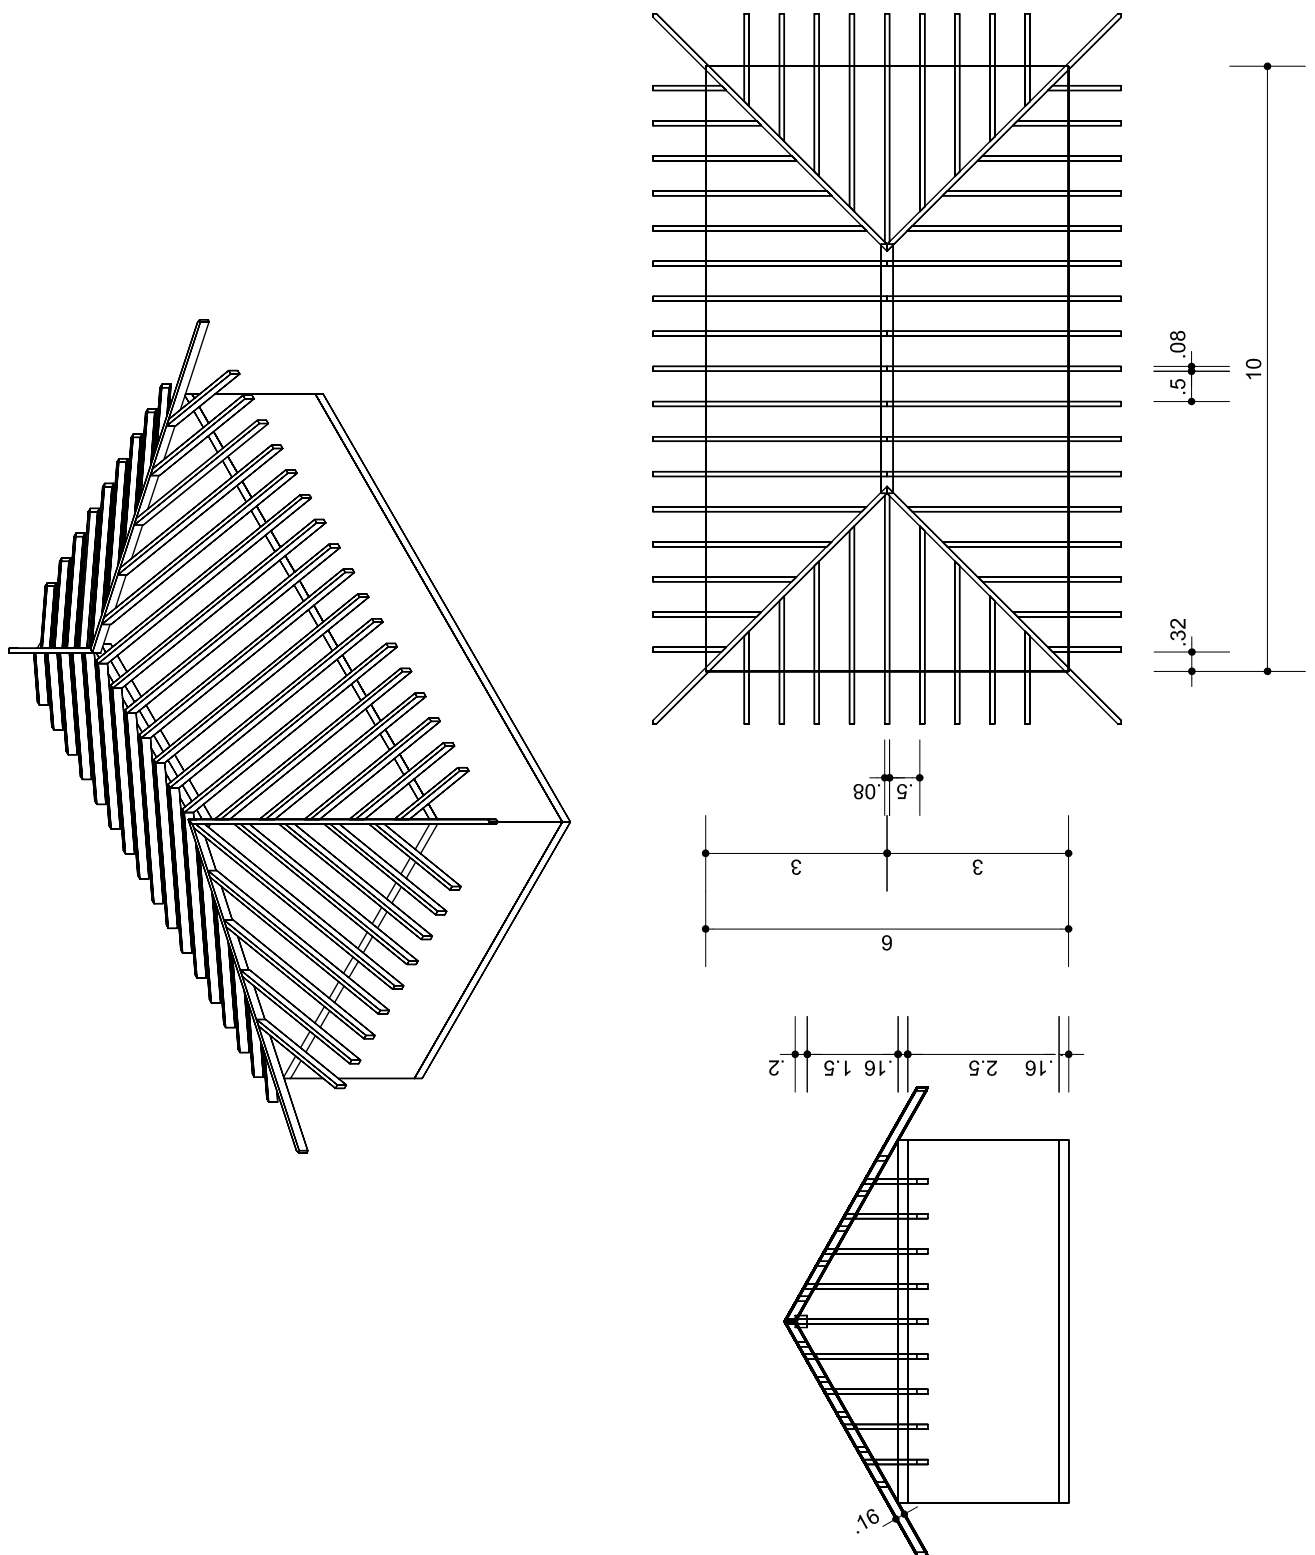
Übung 8 Dachstuhl Walmdach
